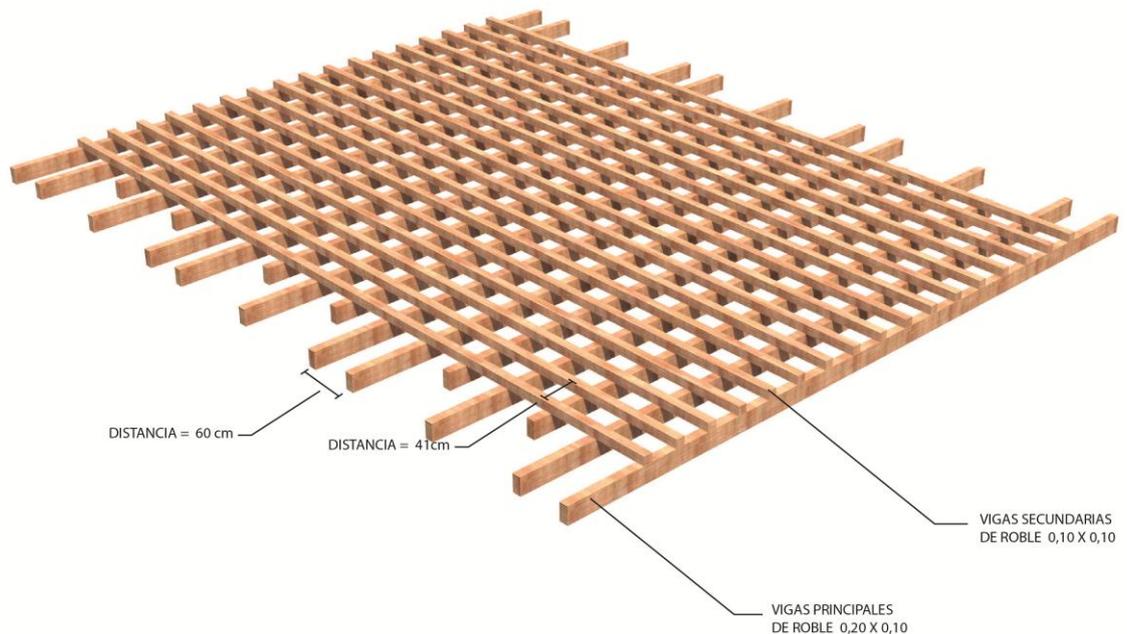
Vigas de roble para la elaboración de la base.
